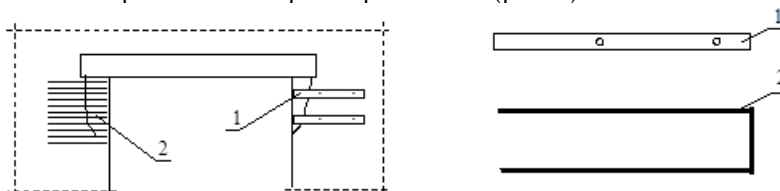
Усиление опорных зон под перемычками с помощью стальных обжим 1 и армирующих стержней 2
